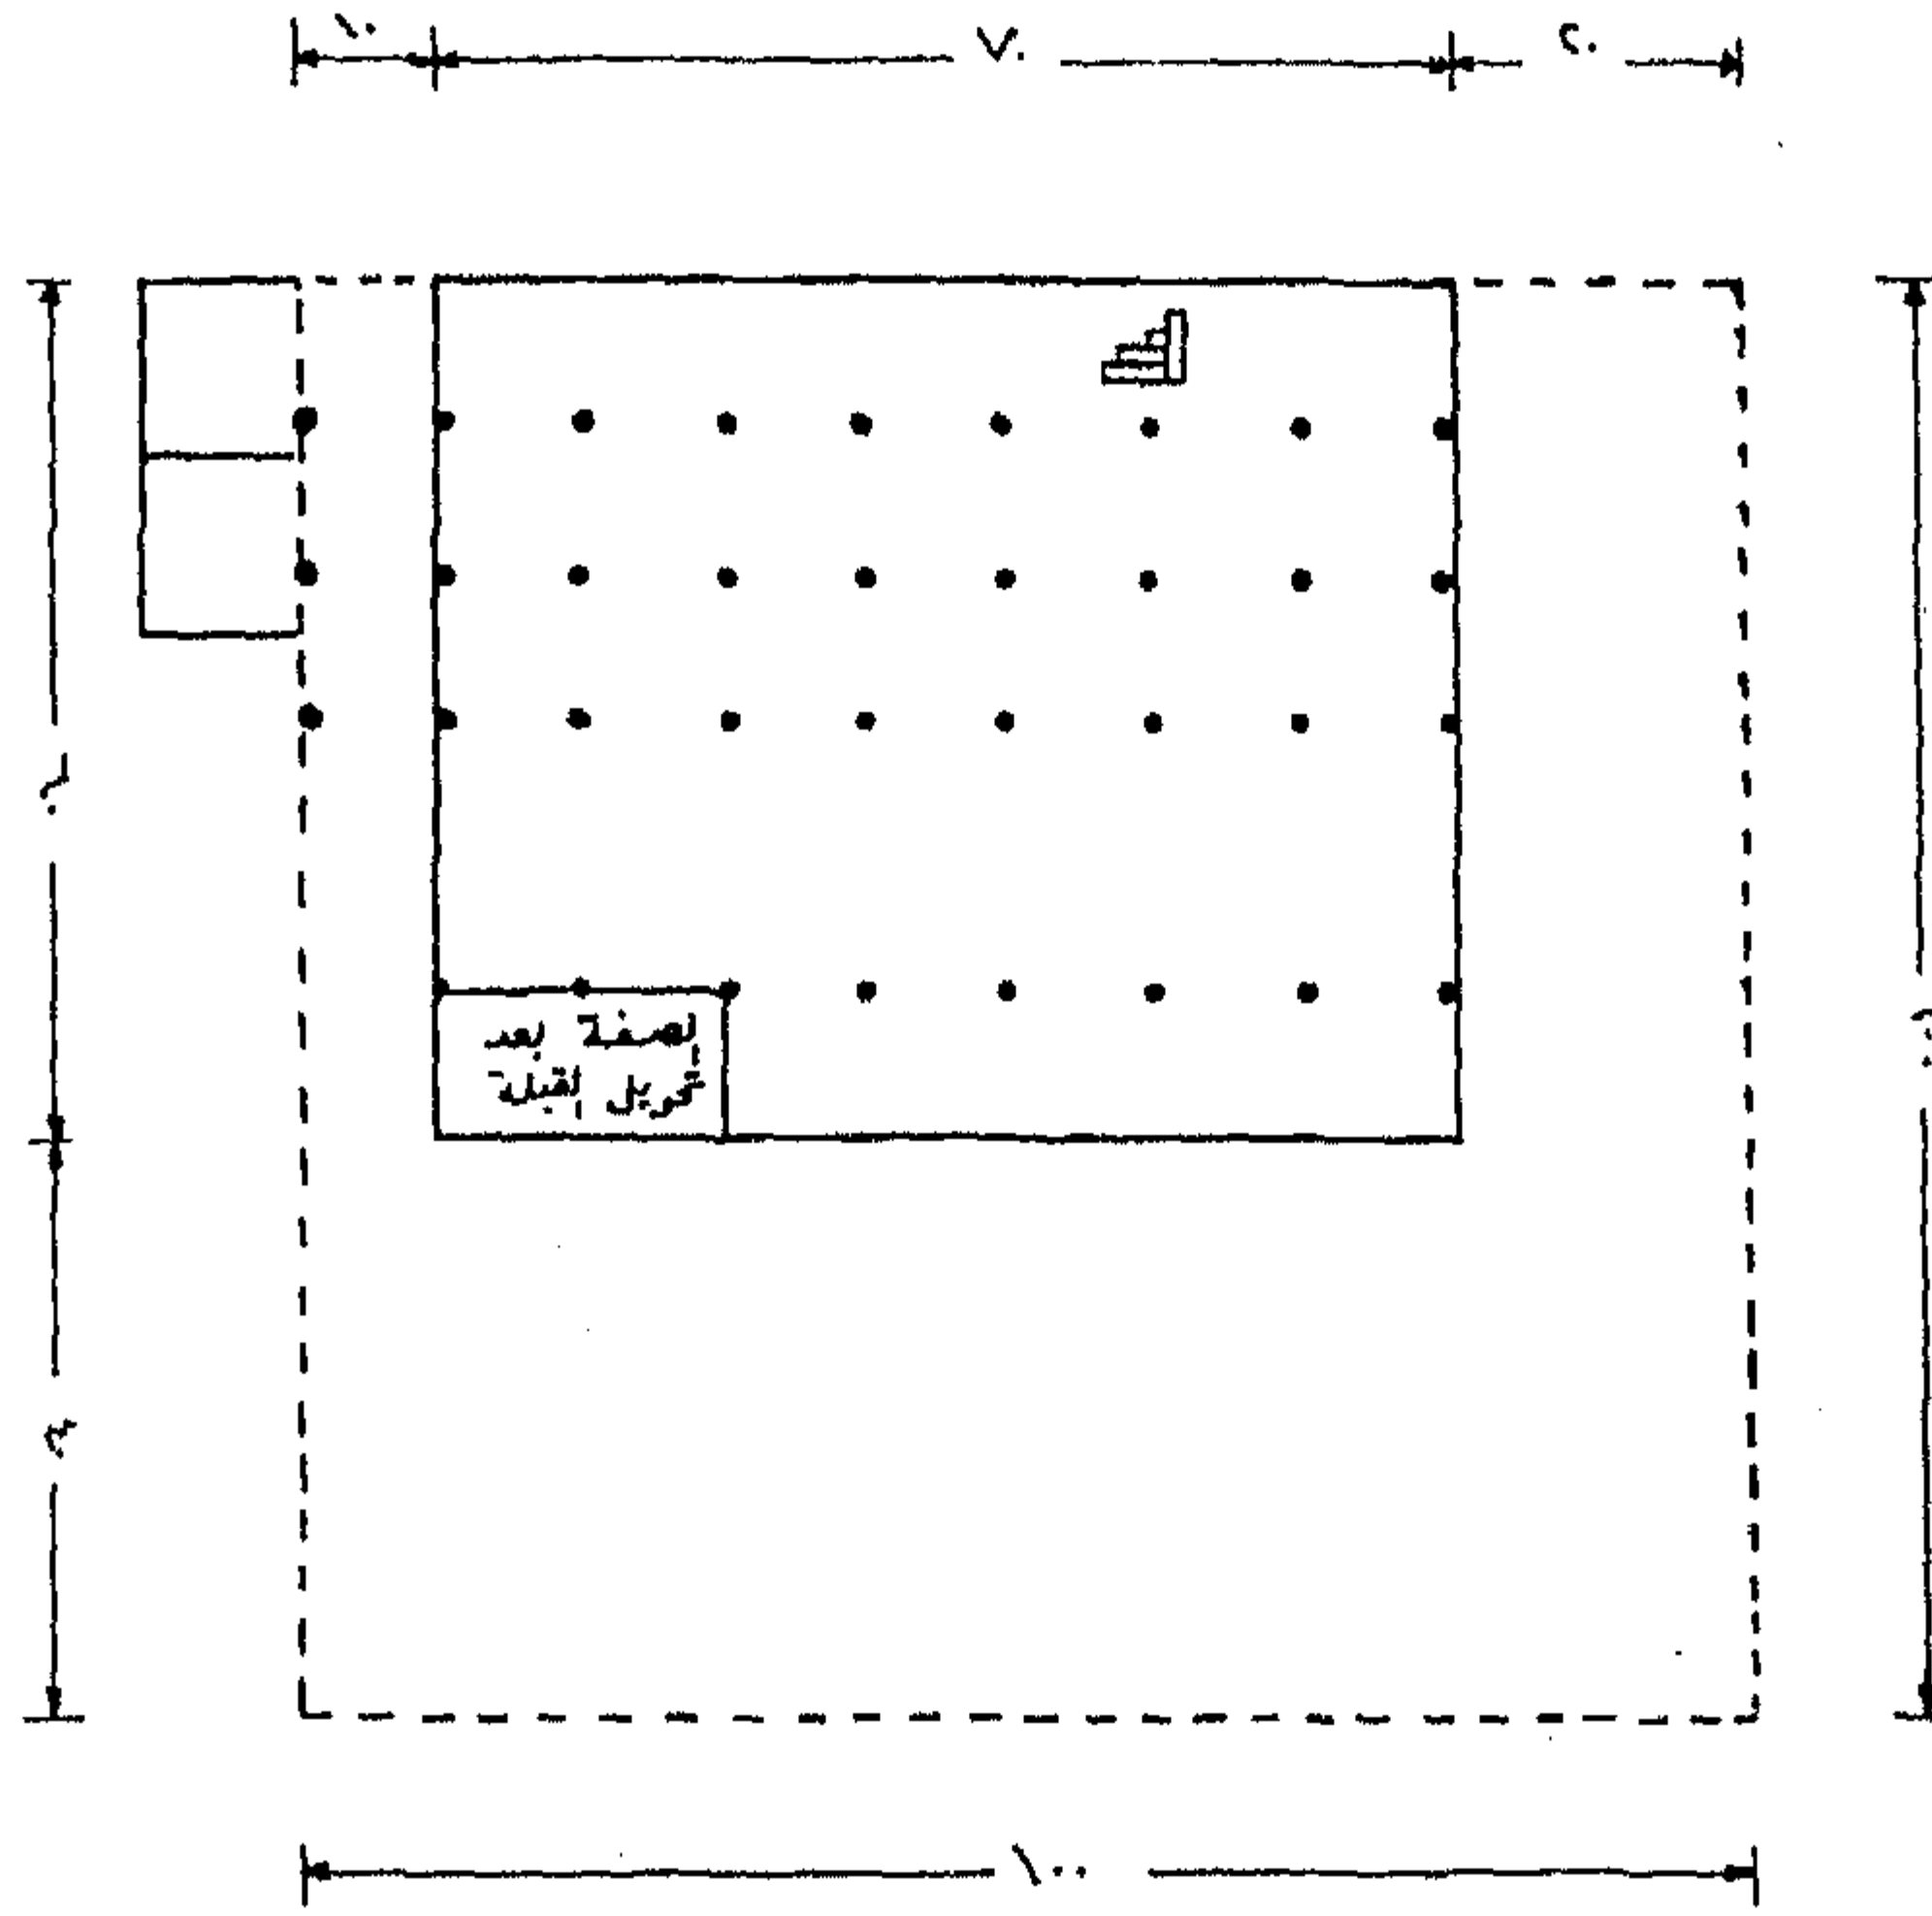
مسقط أفقي للمسجد الأقصى المبارك في عهد المهدي العباسي
